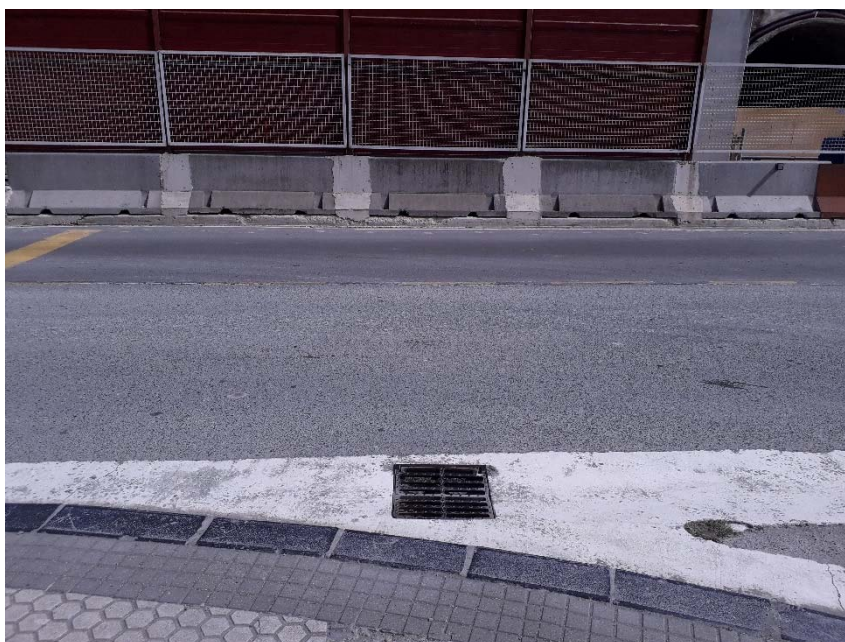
Arqueta red de pluviales en acera opuesta a emboquille
